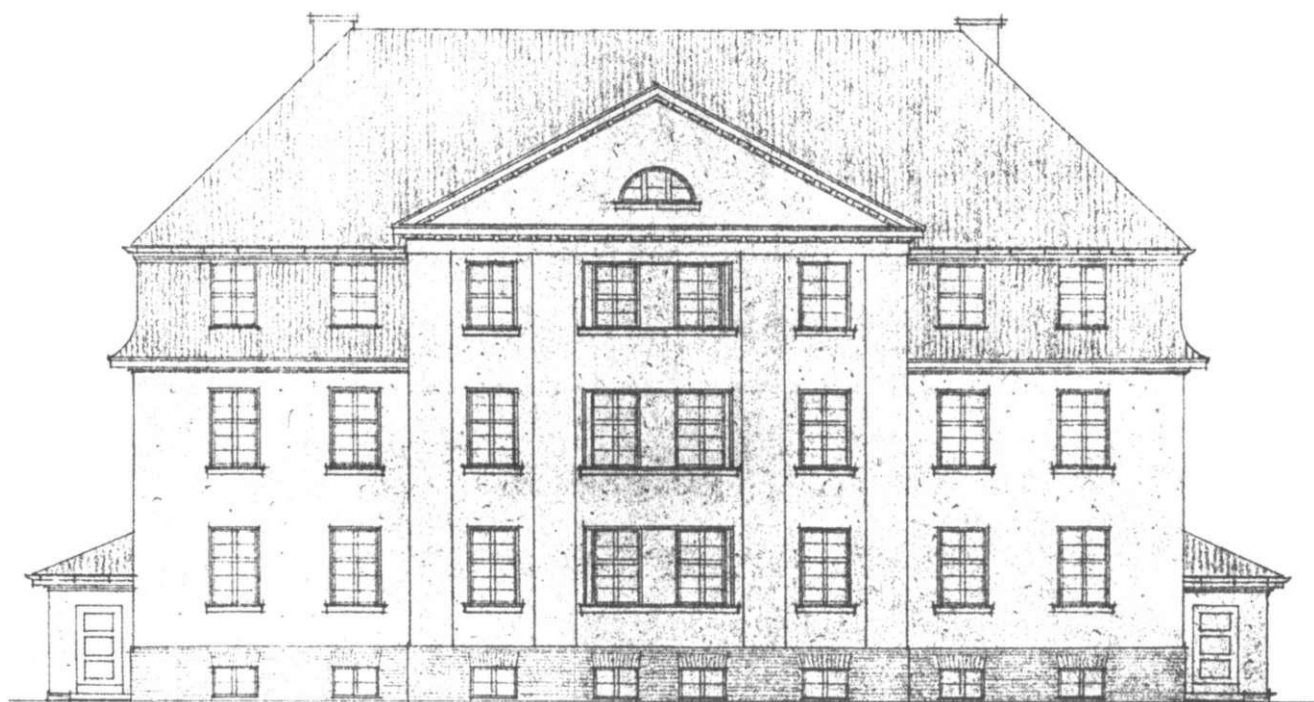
Liebknechtstraße 65-91, Beamtenwohnhaus (Gebäude 14), vom Westring aus gesehen
